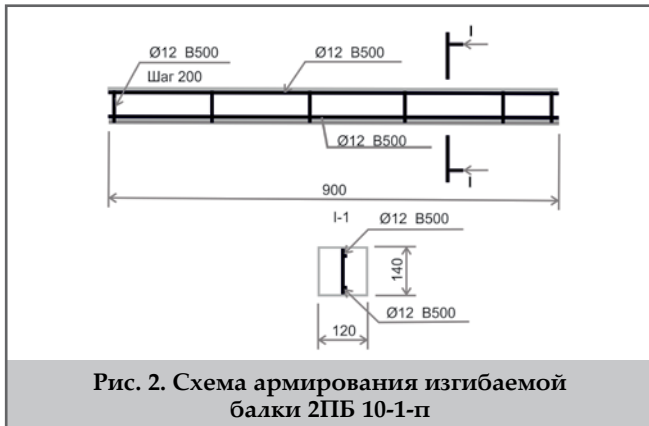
Схема армирования изгибаемой балки 2PB 10-1-п
